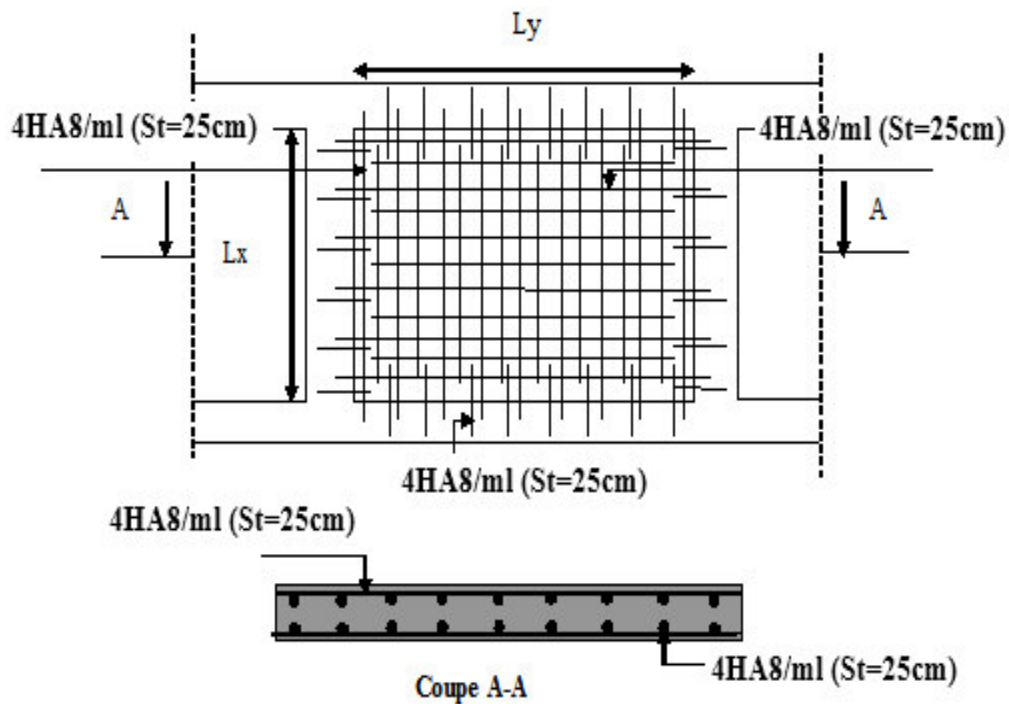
Schéma d ferrailage de voile périphérique.
